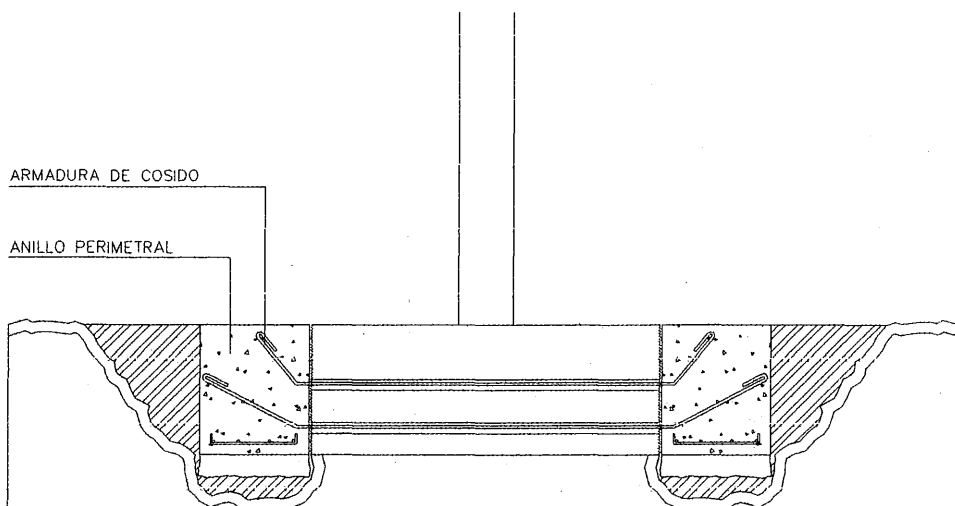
Recalce superficial de zapata aislada aumentando su superficie de apoyo mediante un anillo perimetral unido por armaduras pasantes.
